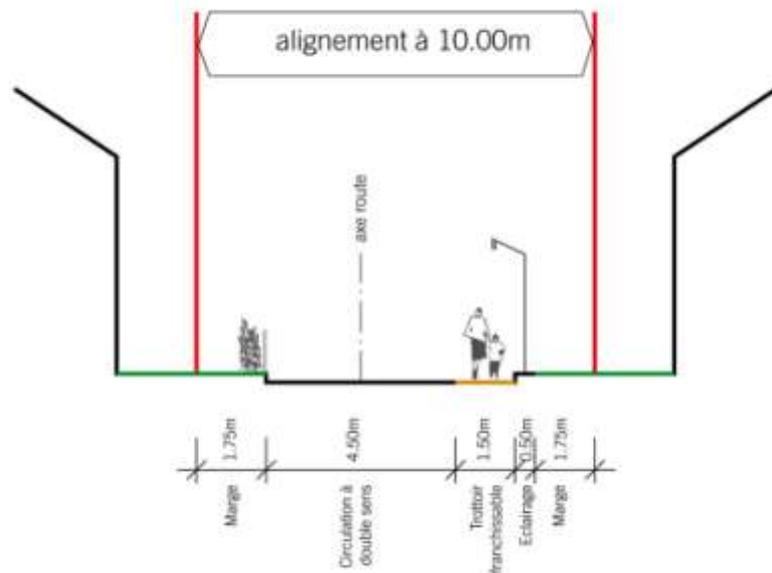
Profil type pour route collectrice ou de desserte sans stationnement
